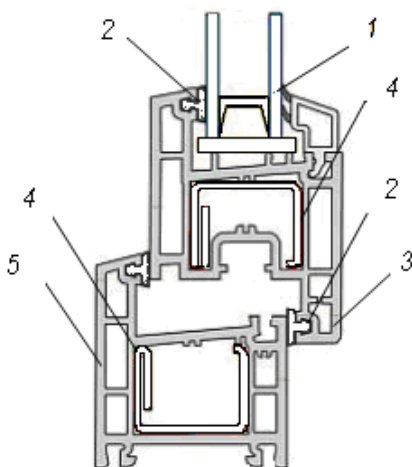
Конструкція металопластикового вікна: 1 – склопакет; 2 – ущільнююча прокладка; 3 – пластикова рама вікна; 4 – металевий профіль; 5 – пластикова рама коробка
